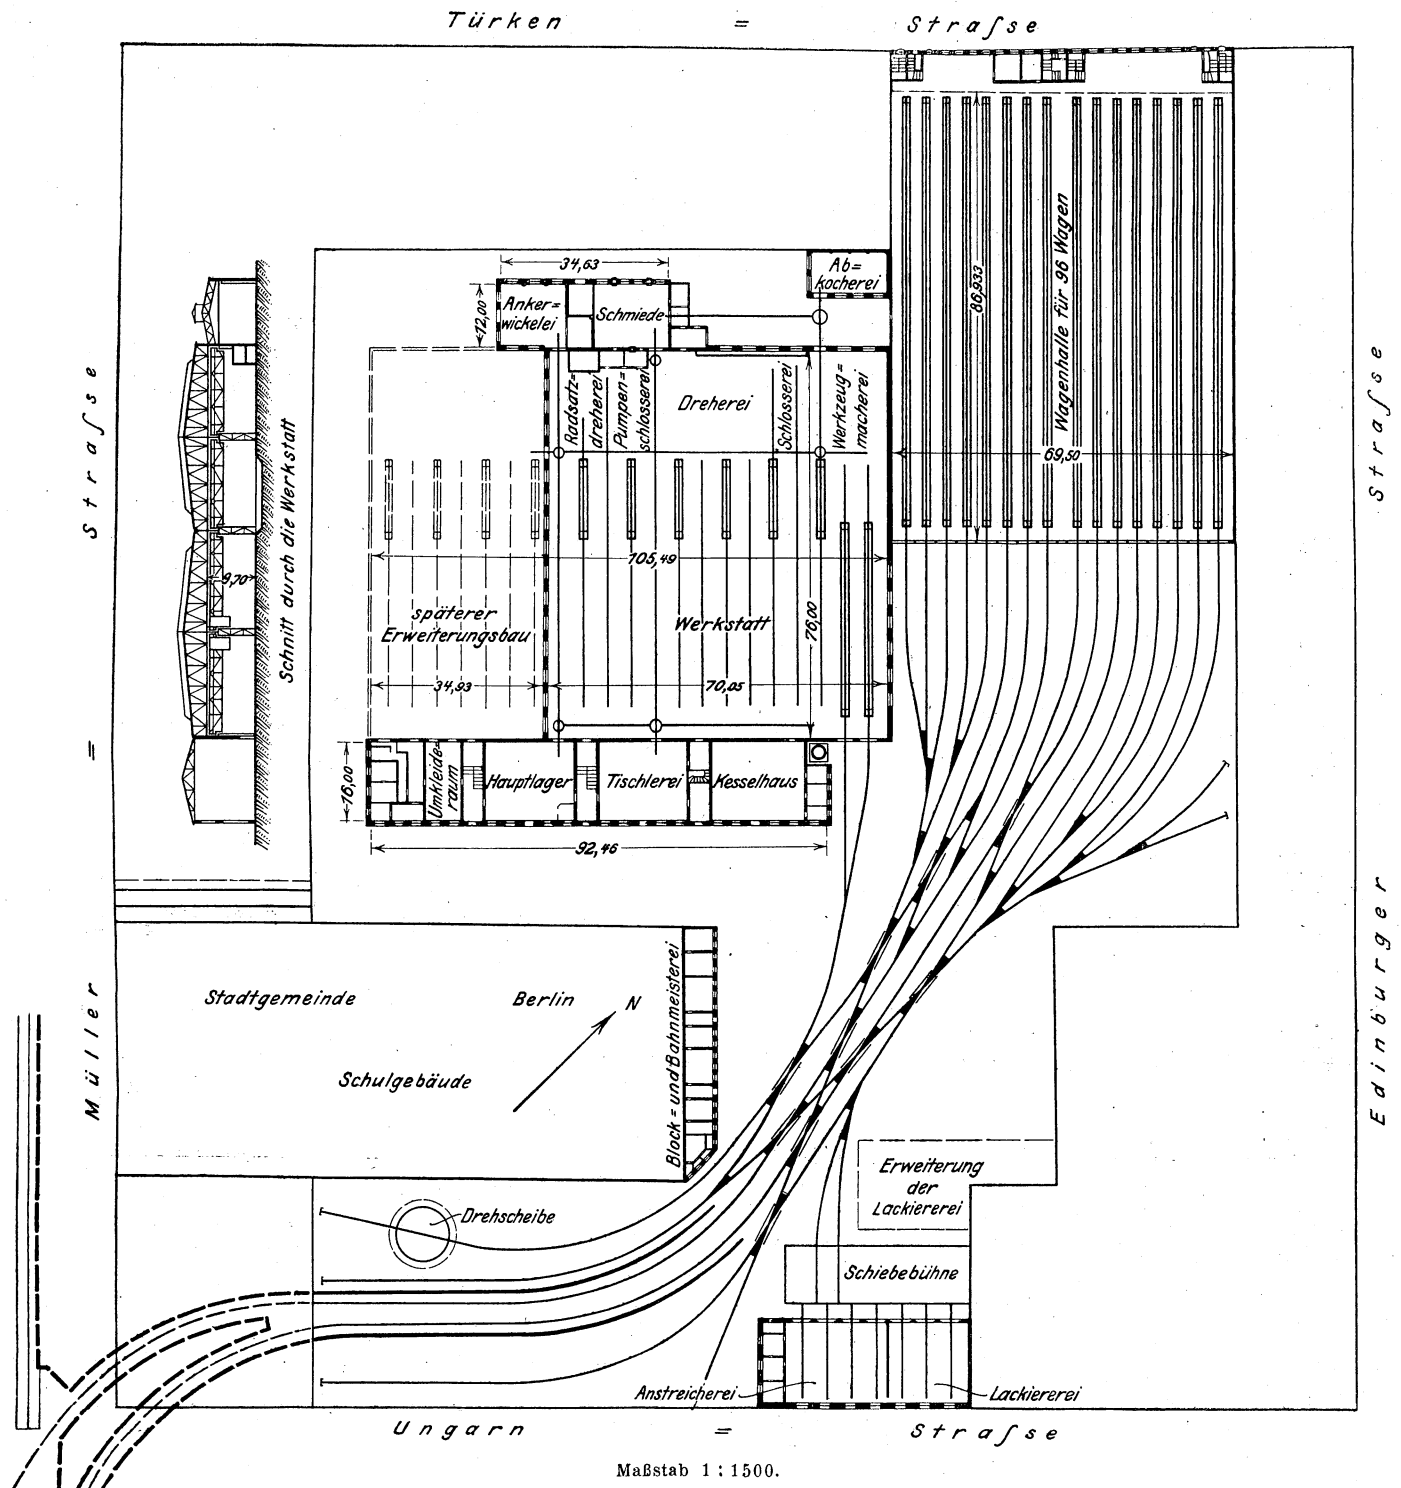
und 41. Nord-Süd-Bahn. Betriebsbahnhof und Hauptwerkstatt, Lageplan und Schnitt.
